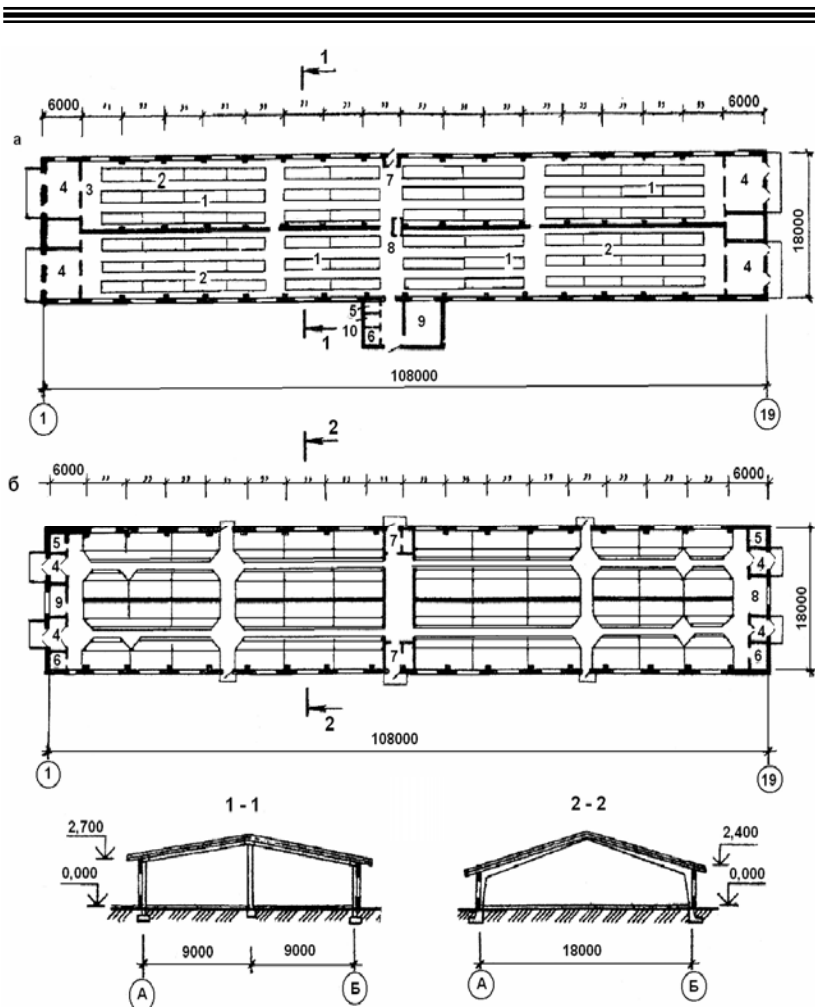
Об'ємно-планувальне рішення будівель свинарників:
